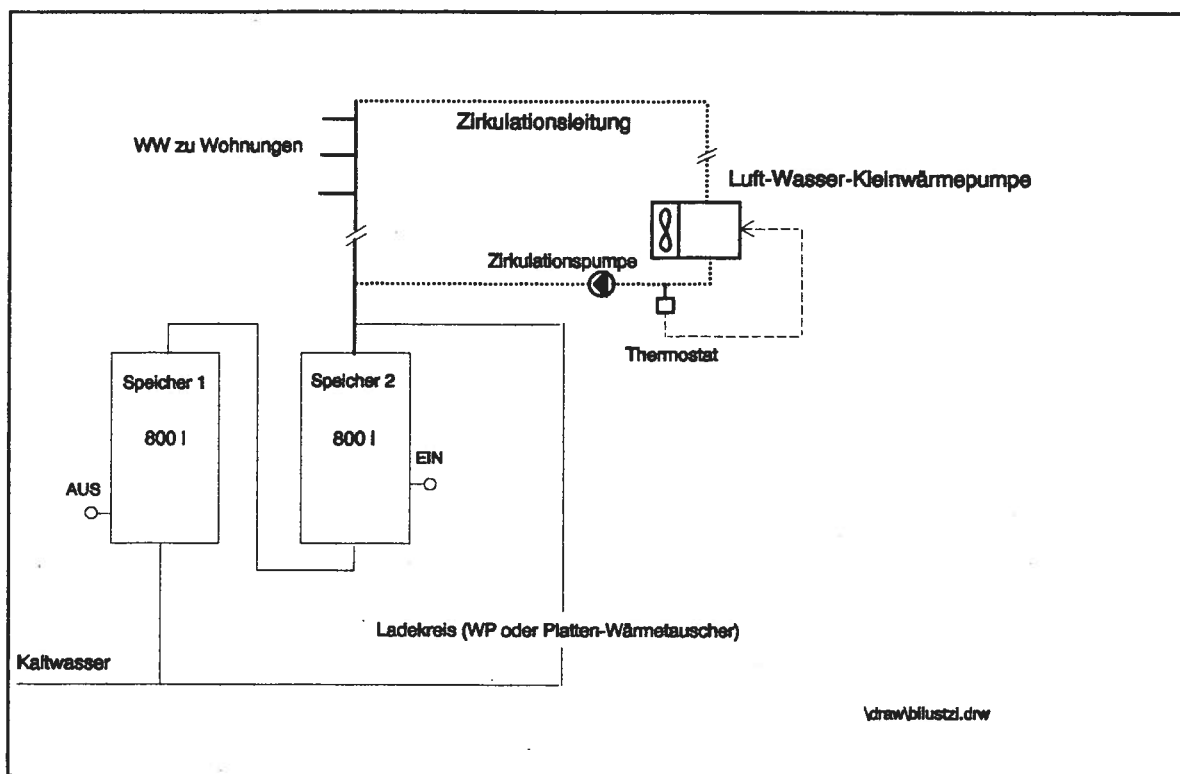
Prinzipschema der Zirkulationshochhaltung mit anschlussfertigen Luft-Wasser-Kleinwärmepumpen
